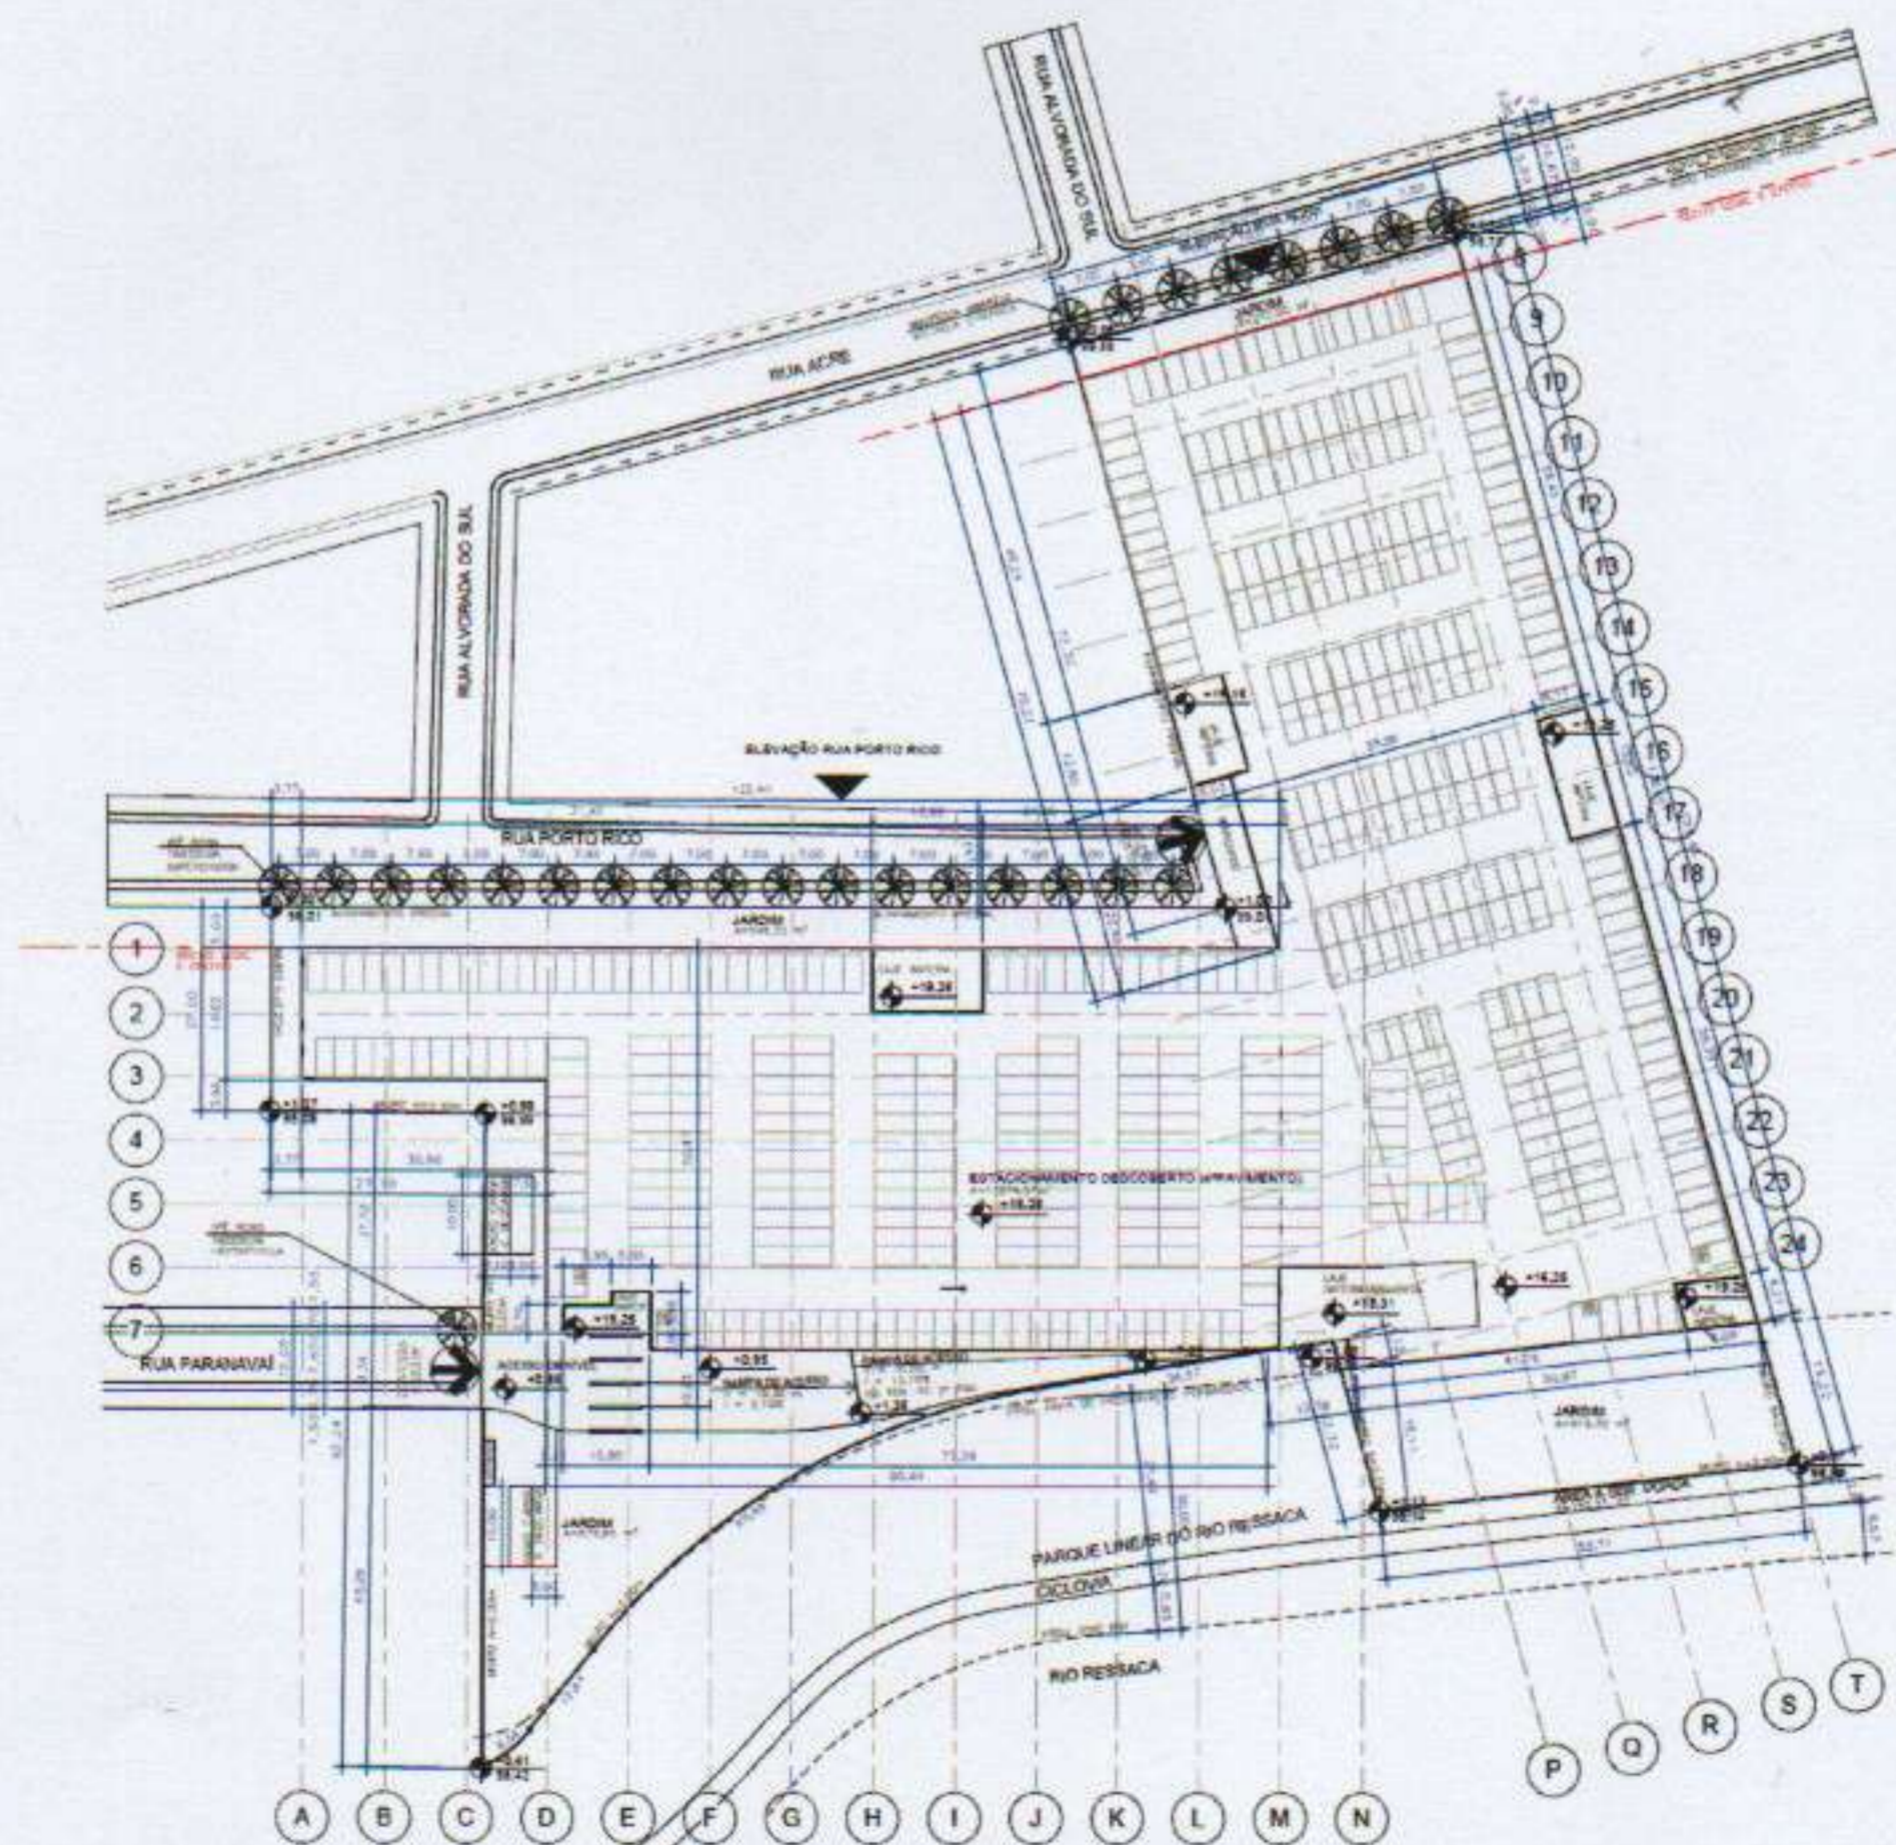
Implantação e Cobertura – Outlet São José dos Pinhais
